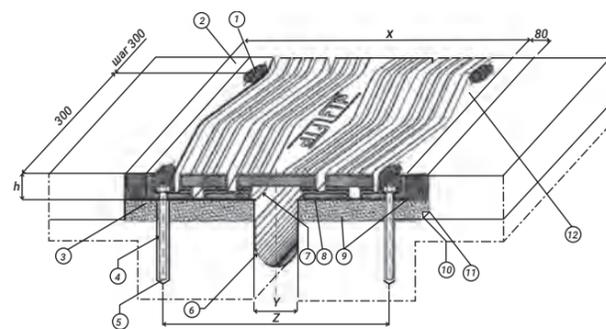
Схема металлической конструкции деформационного шва FIP: 1 — отверстие для крепежа; 2 — переходная полоса; 3 — основание деформационного шва; 4 — крепежные детали; 5 — клей; 6 — дренажный лоток; 7 — лист скольжения; 8 — выравнивающий слой; 9 — праймер; 10 — дренажный профиль; 11 — клей дренажного профиля; 12 — резинометаллический модуль
